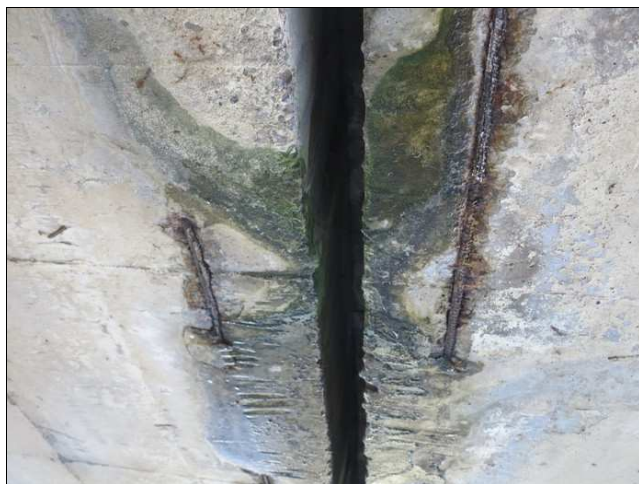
K 01, silné průsaky, degradace betonu a nedostatečné krytí výztuže ve střední části.
